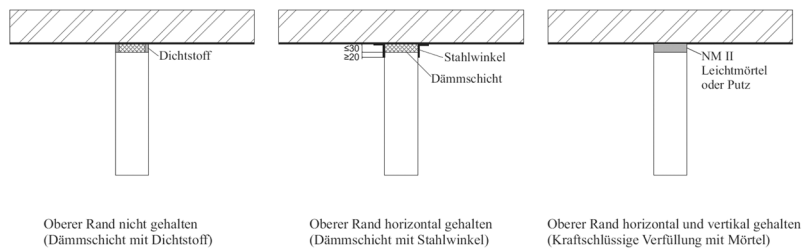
Wand-Deckenanschlüsse für ausfachende Mauerwerksände (Schmitt [110])
